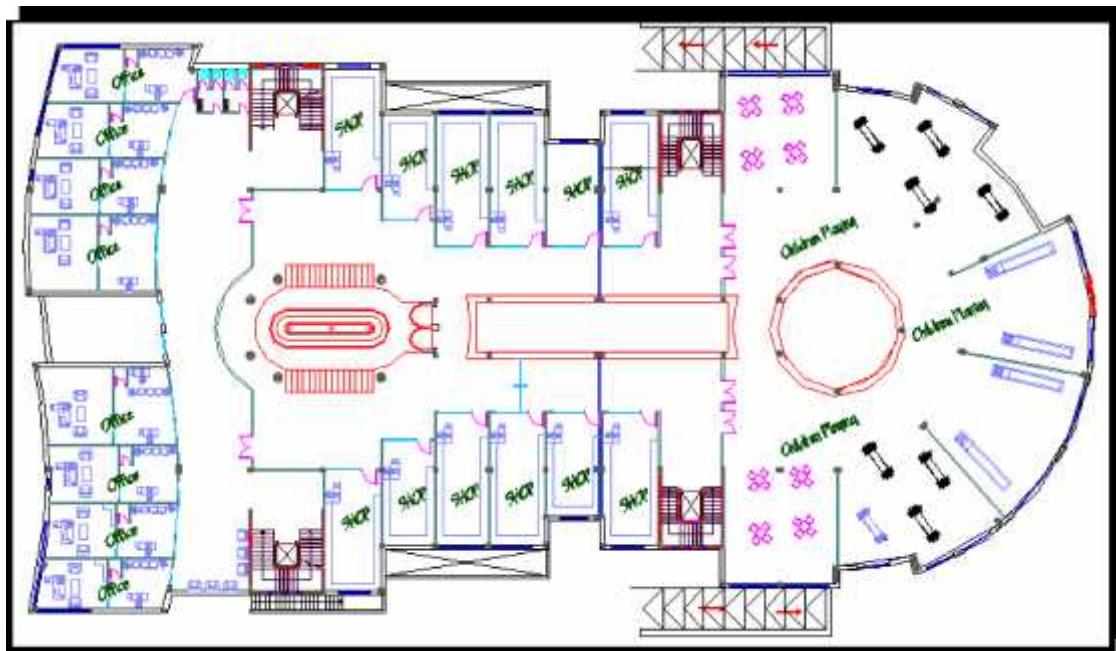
5) : المسقط الأفقي للطابق الأول
